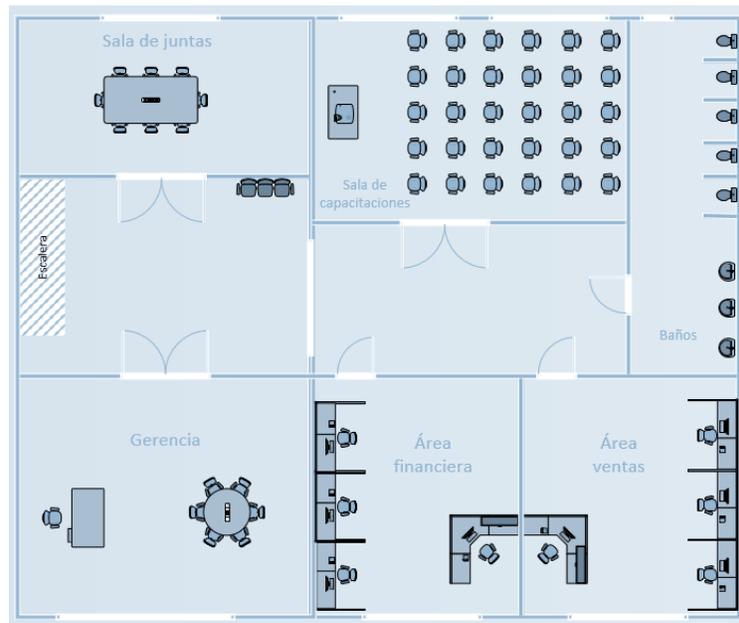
Imagen Plano área administrativa AMEDIDA – Segundo piso. Fuente: construcción de los autores.
